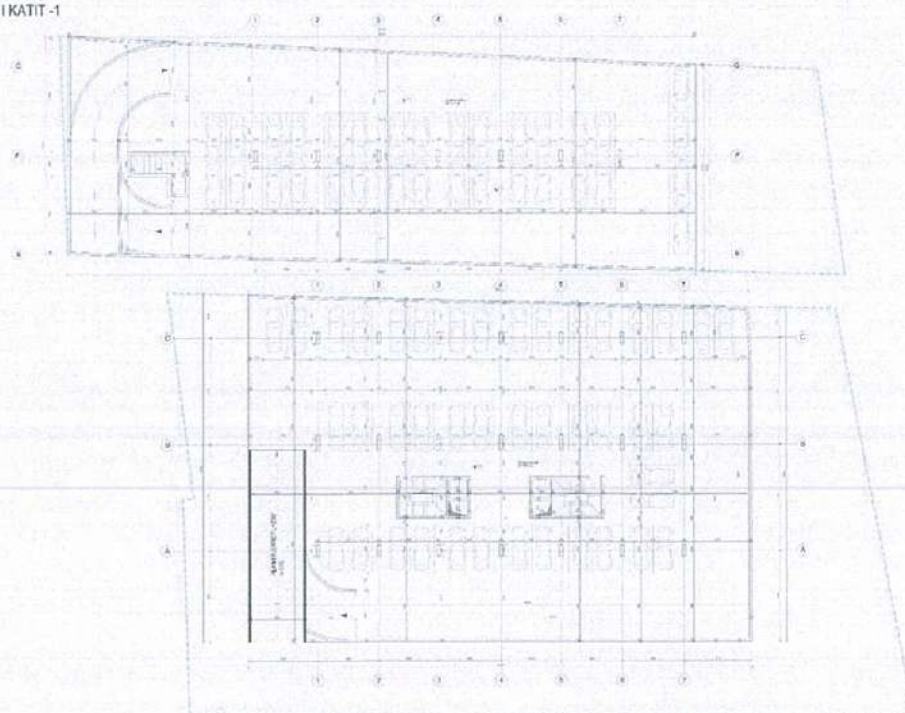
Planimetri Kati -1 (Parkim nëntokesor)
